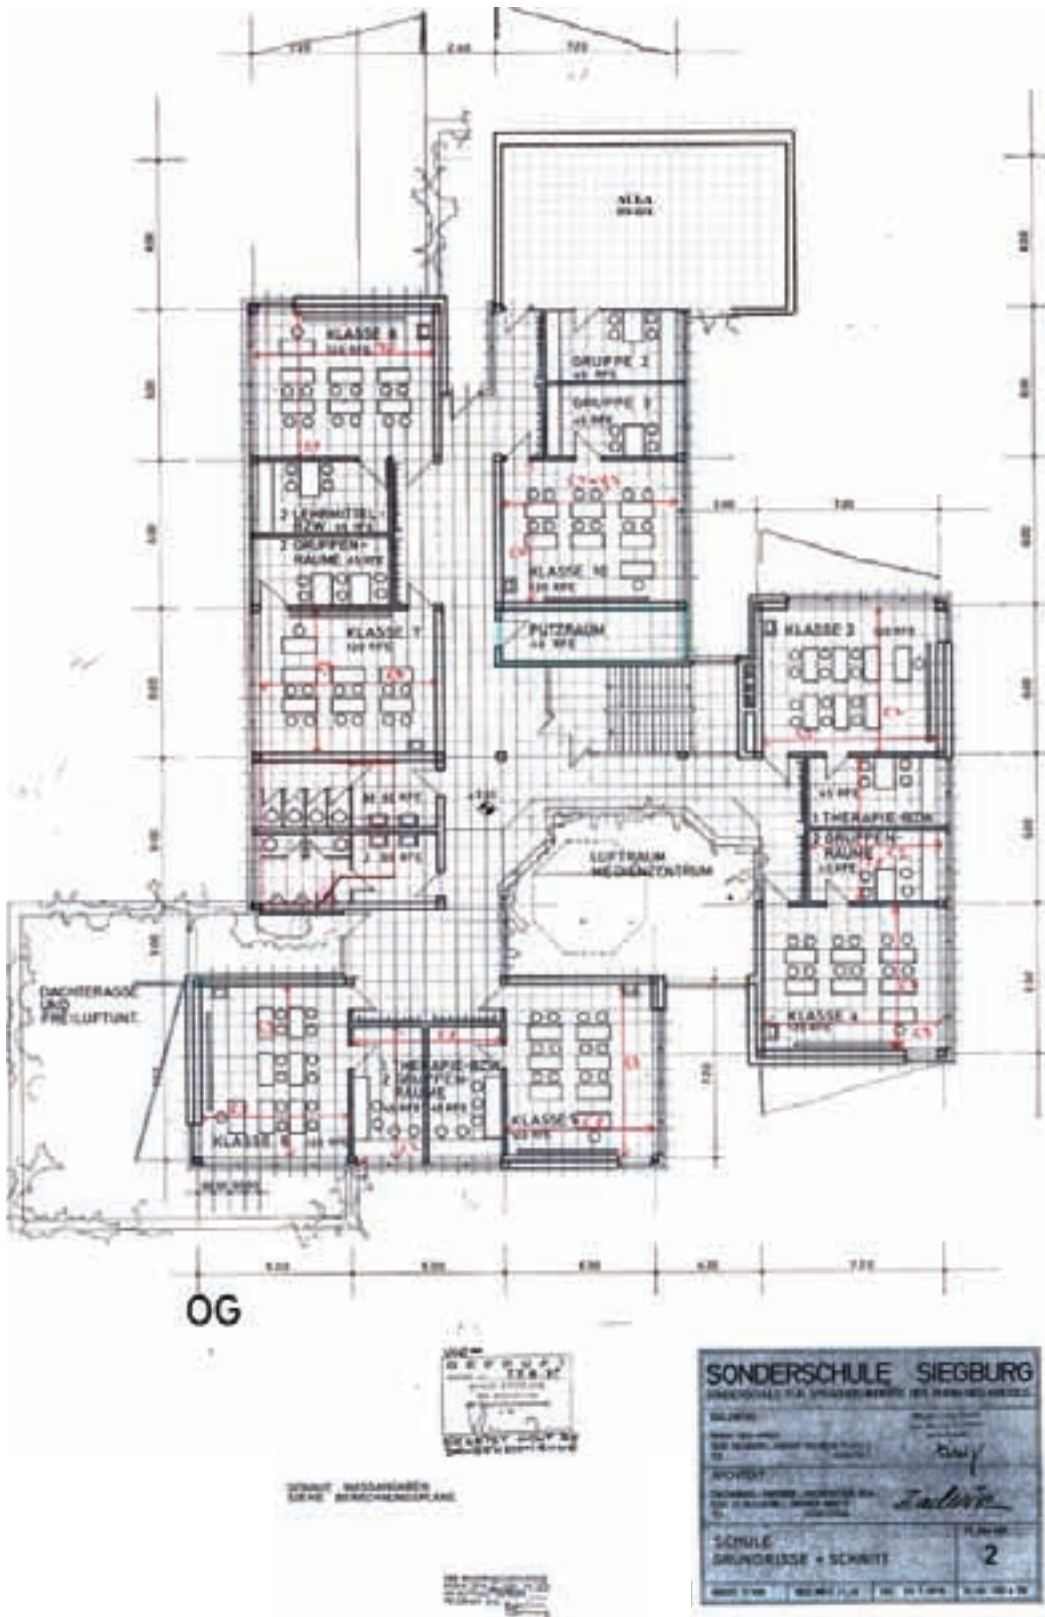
Grundriss 1. Obergeschoss Schule
